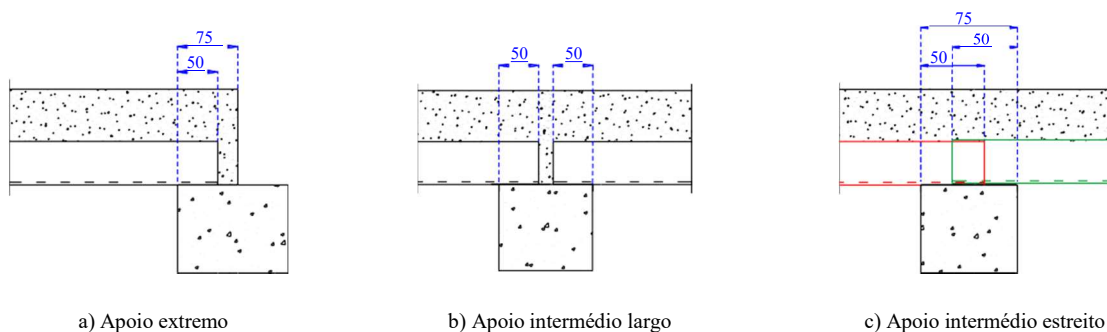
Distâncias mínimas [mm] de apoio em vigas de betão armado.
